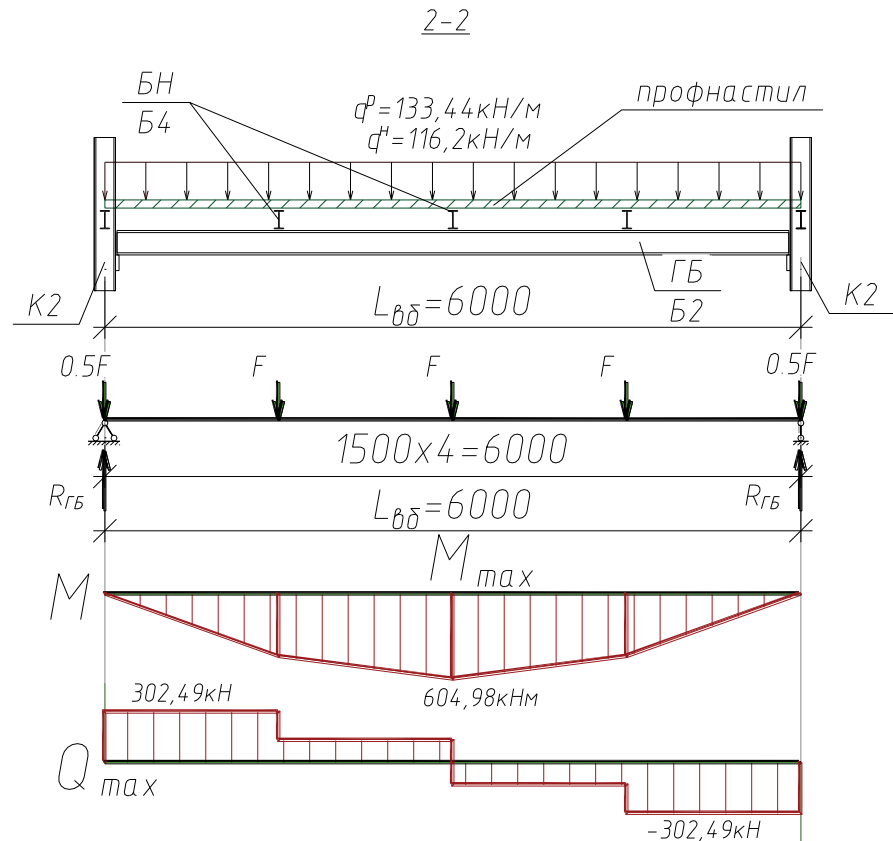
Конструктивная и расчетная схемы главной балки Б2
